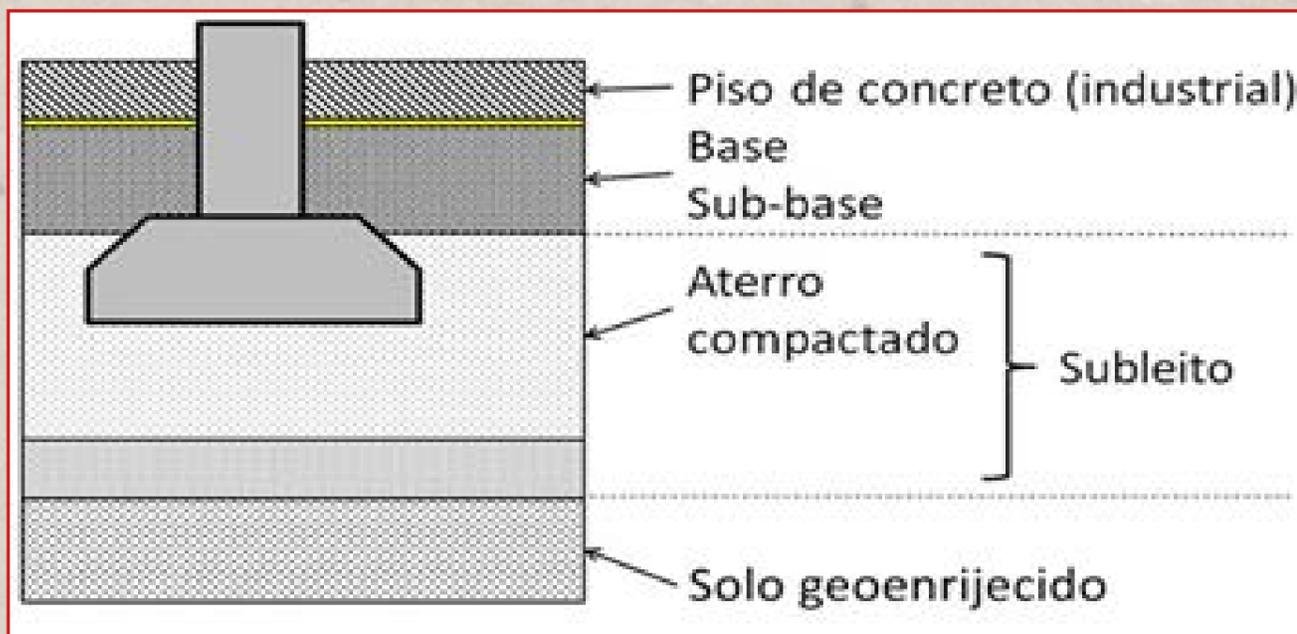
O solo mole geoenrijecido, com CPR Grouting, fica apto a receber as cargas do aterro, do pavimento e da estrutura sem qualquer deformação.
